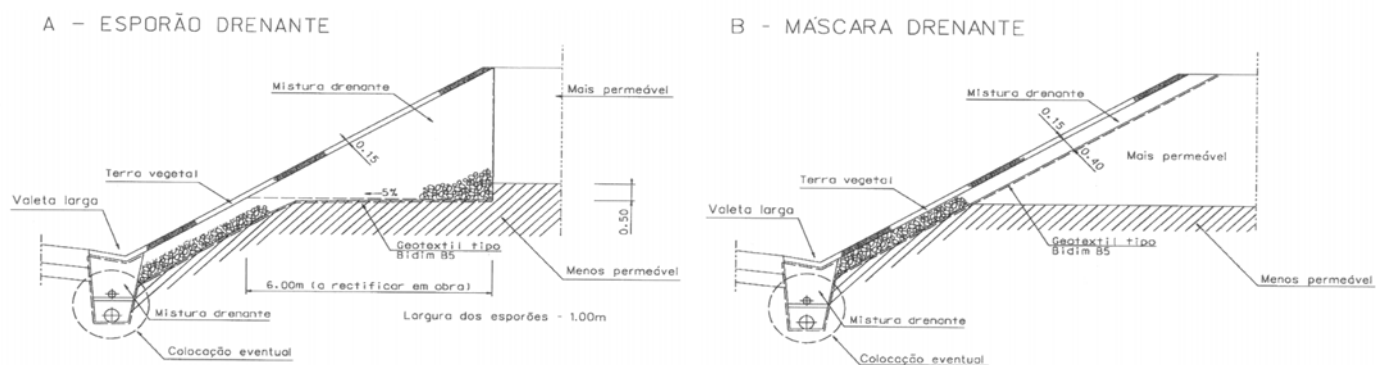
Esquema de dispositivos de drenagem sub-superficial do tipo esporão drenante e máscara drenante
